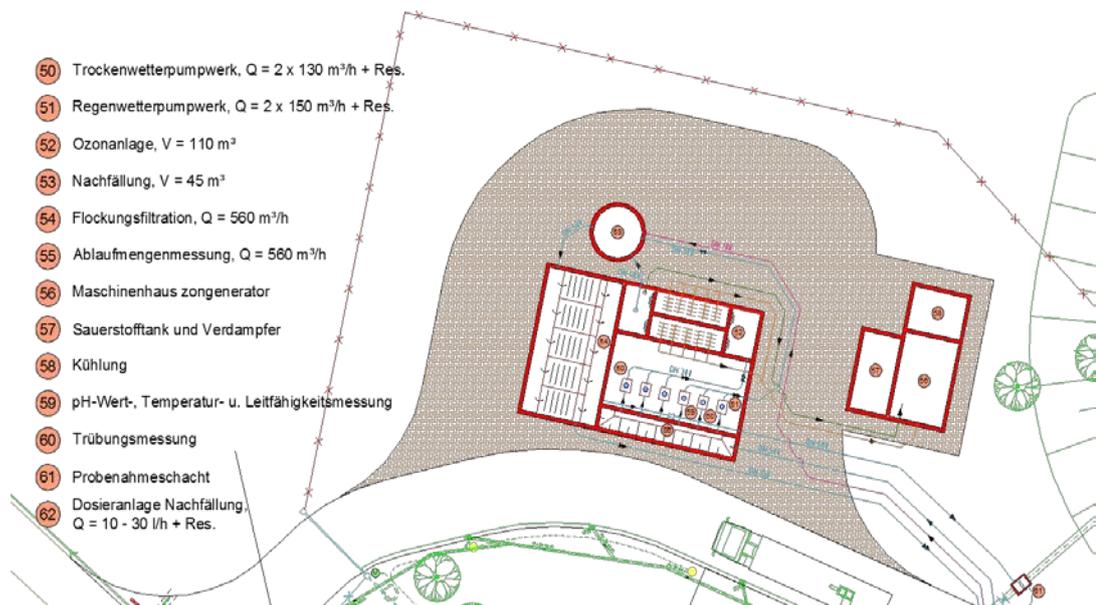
Ozonbehandlung, Lageplan, Ausschnitt
